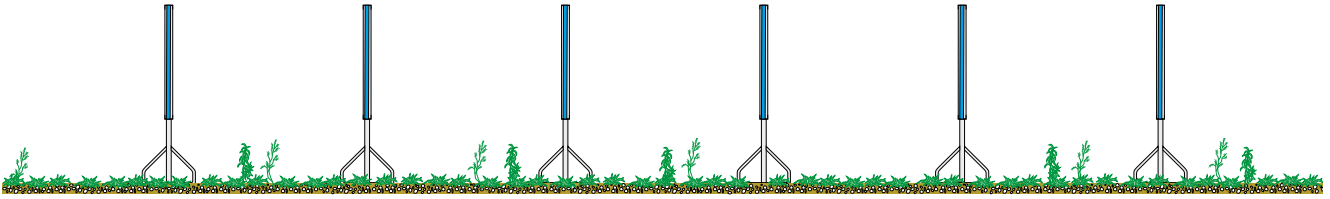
Installation PV orientée à l'est/ouest avec une structure de substrat modelée de hauteur différente, source: Zinco
